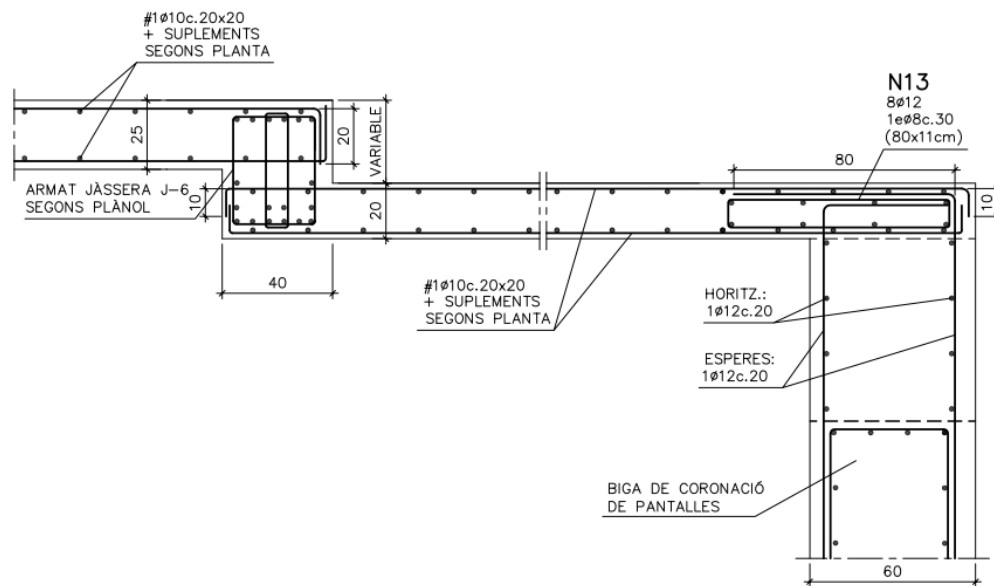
Características de la losa maciza de 20 cm (Fuente: Planos estructurales del edificio K2M)
